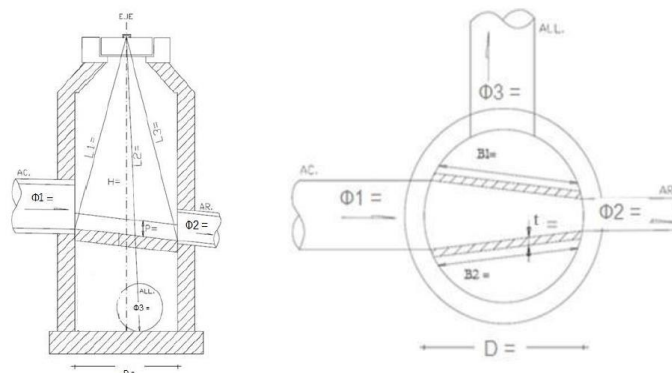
Vista en perfil y planta del aliviadero de cañuela elevada en cámara.
